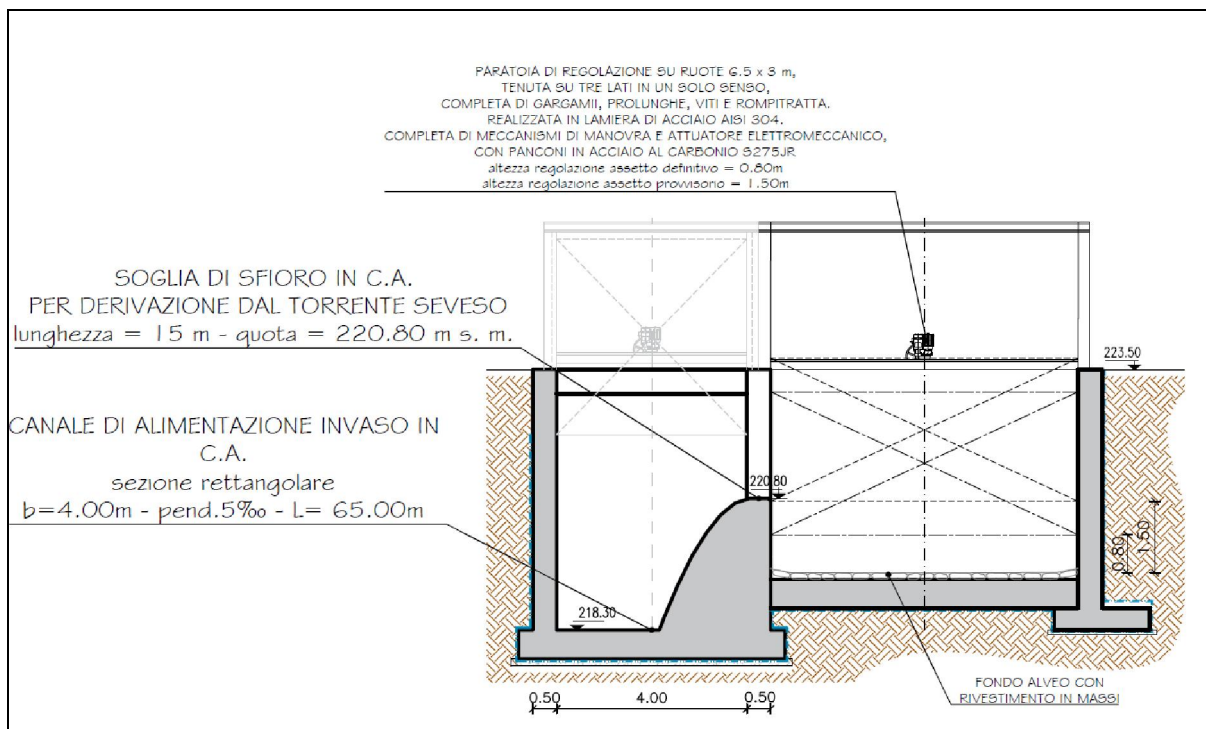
Sezione trasversale di progetto (C-C) dell'opera di presa dal T. Seveso
